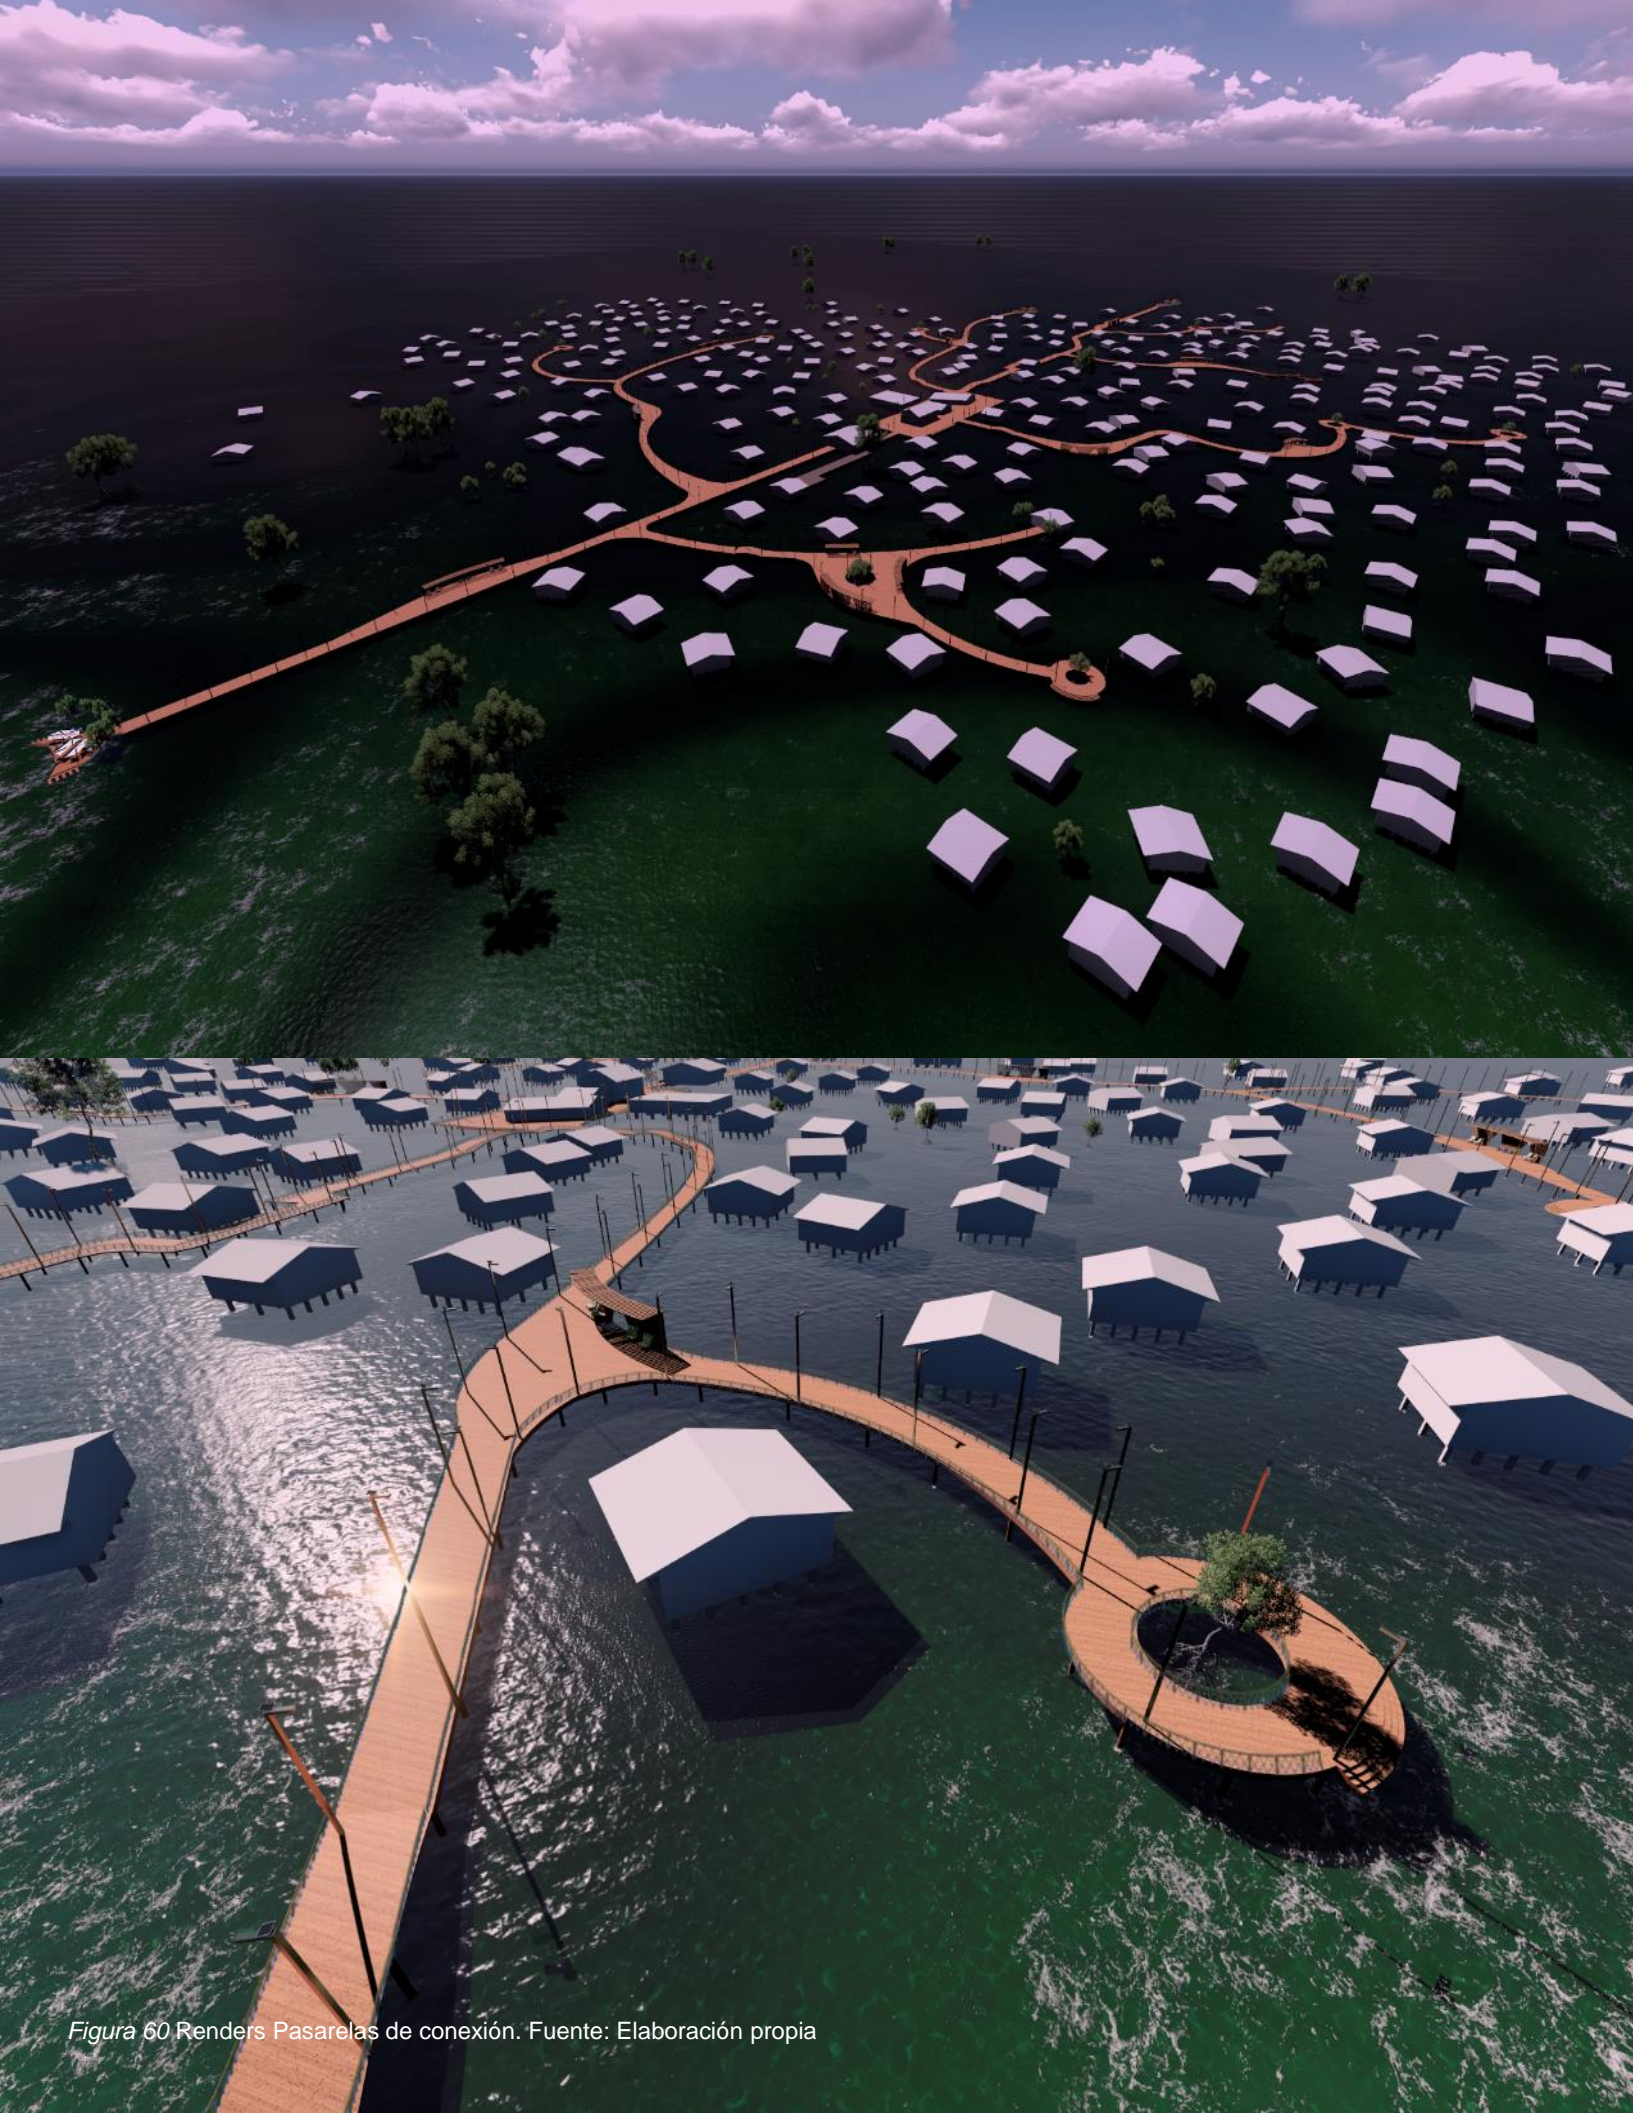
Renders Pasarelas de conexión. Fuente: Elaboración propia
